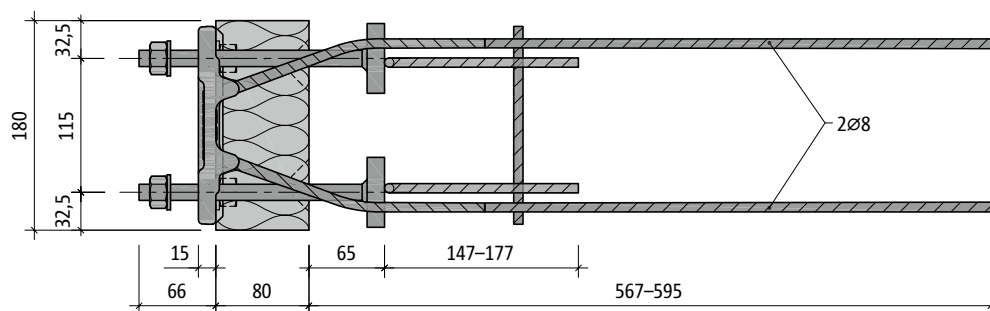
Schöck Isokorb® T type SQ-V1 : vue en plan
